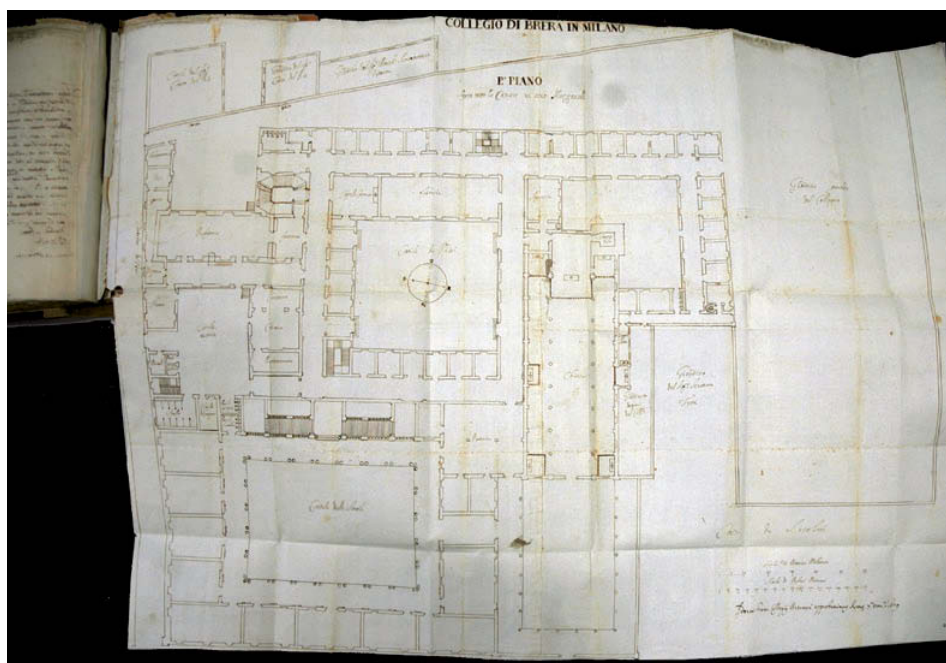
Pianta del piano terreno del Collegio di Brera, con approvazione e scalimetro a doppia unità di misura, Milano, 1670-1679. ARSI, Med. 87, f. 208 (VR 163 App. II).
